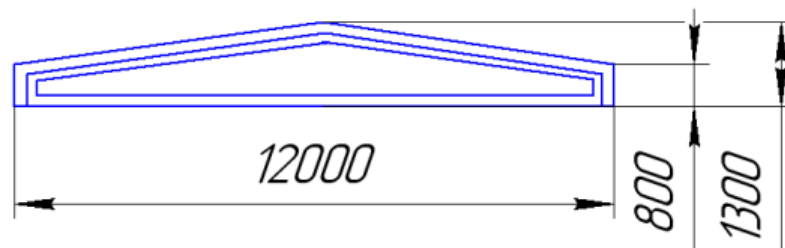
Железобетонная ферма серии 1.462-3
